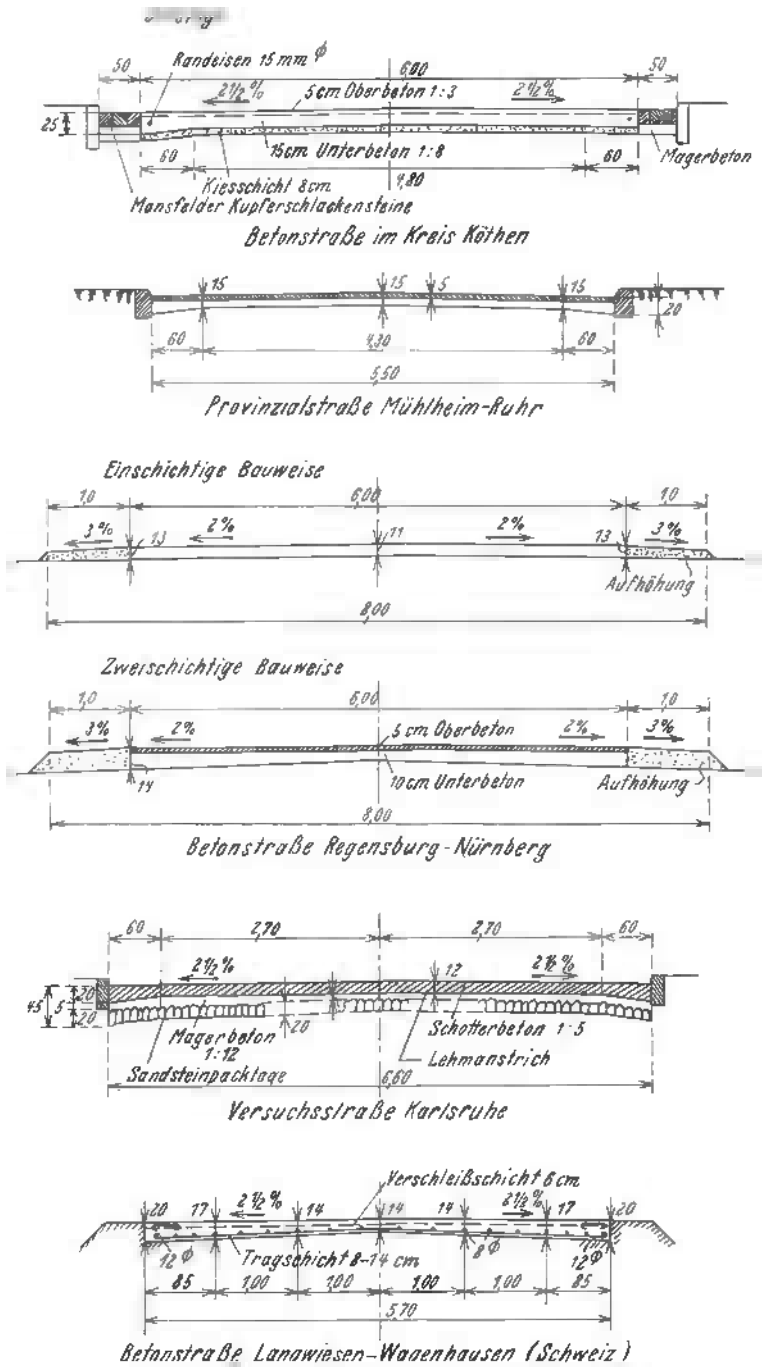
(Fortsetzung). Querschnitte von Betondecken in Deutschland und in der Schweiz.
